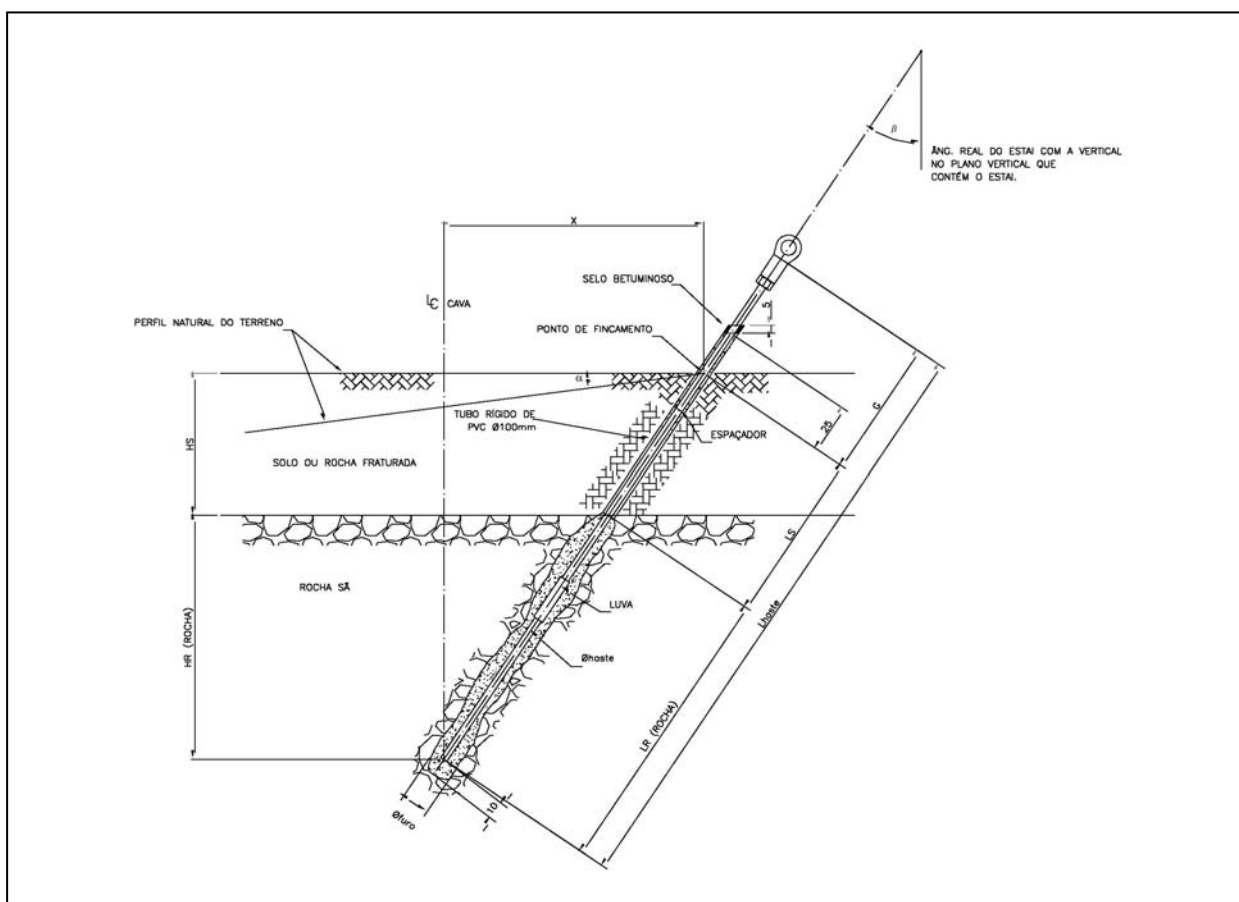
Fundação Tipo Tirante Injetável em Rocha (“Rock Drill”).
